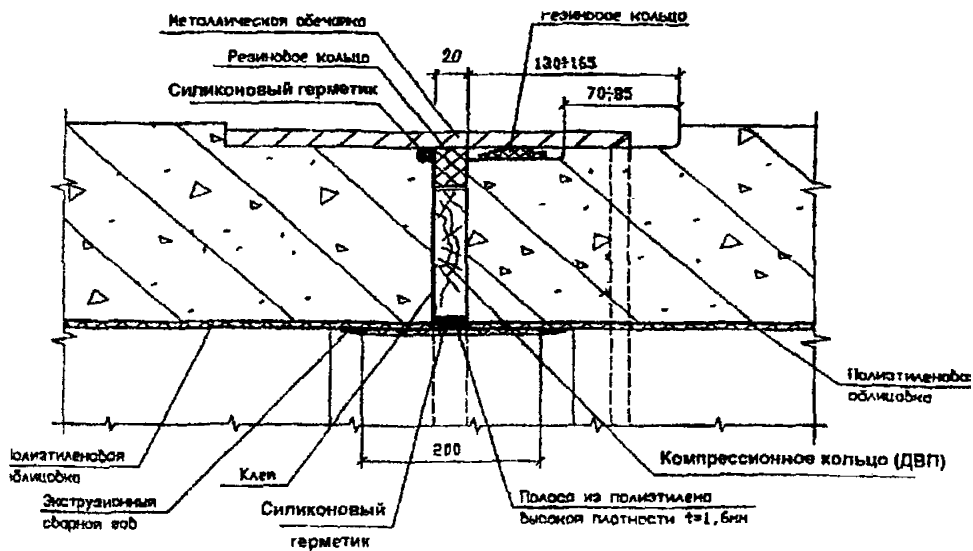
Схема стыкового соединения железобетонных труб ТСМ 200.300-1, ТСМ 200.300-2 и ТСМ 200.300-3
